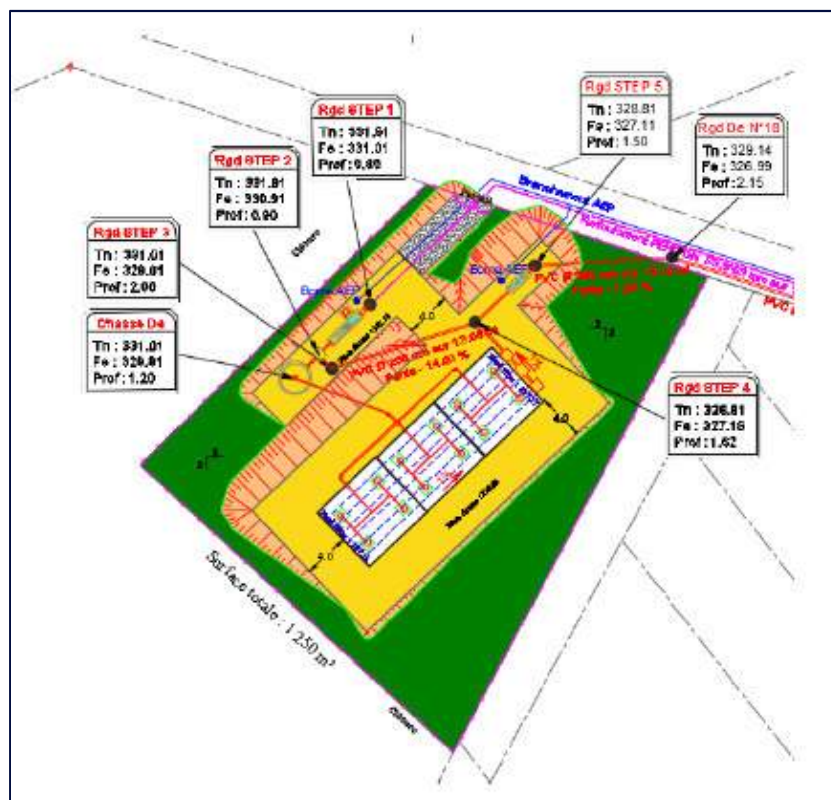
Extrait du plan masse rapport "Projet" de la STEU
